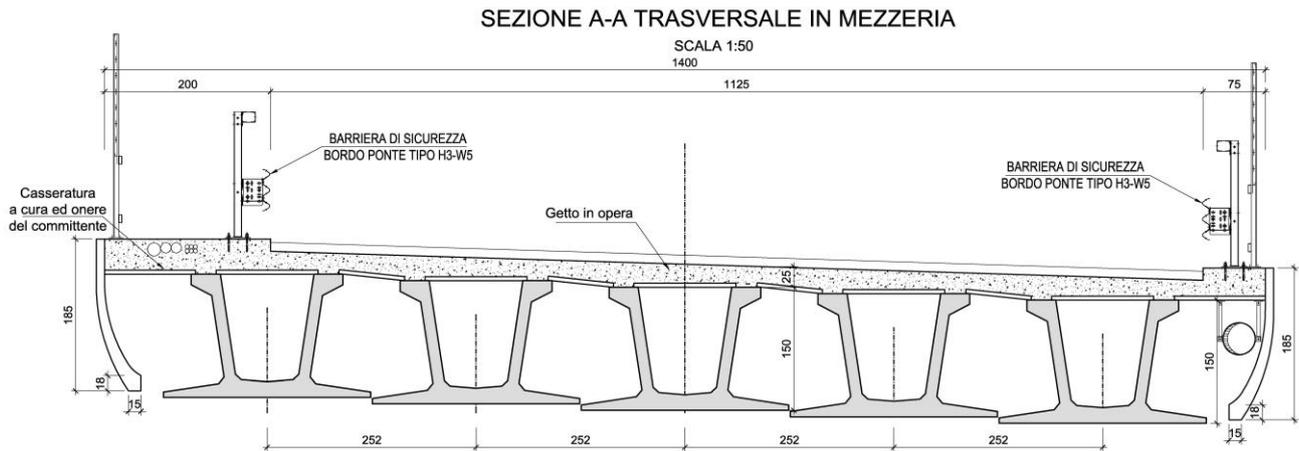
Sezione Ponte Roggia Branza – asse Nord
